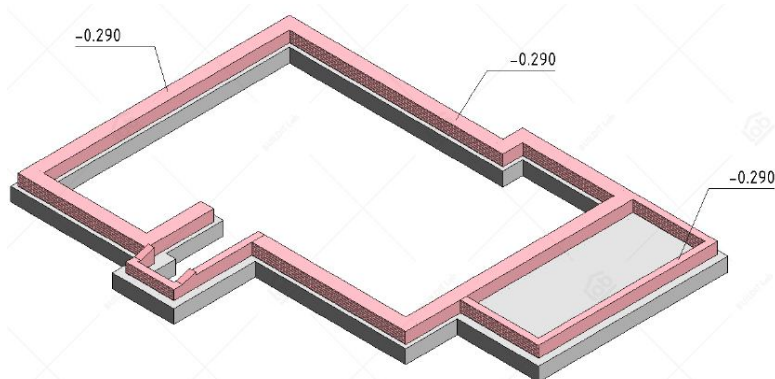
Налаштування плити перекриття на Тип 2
